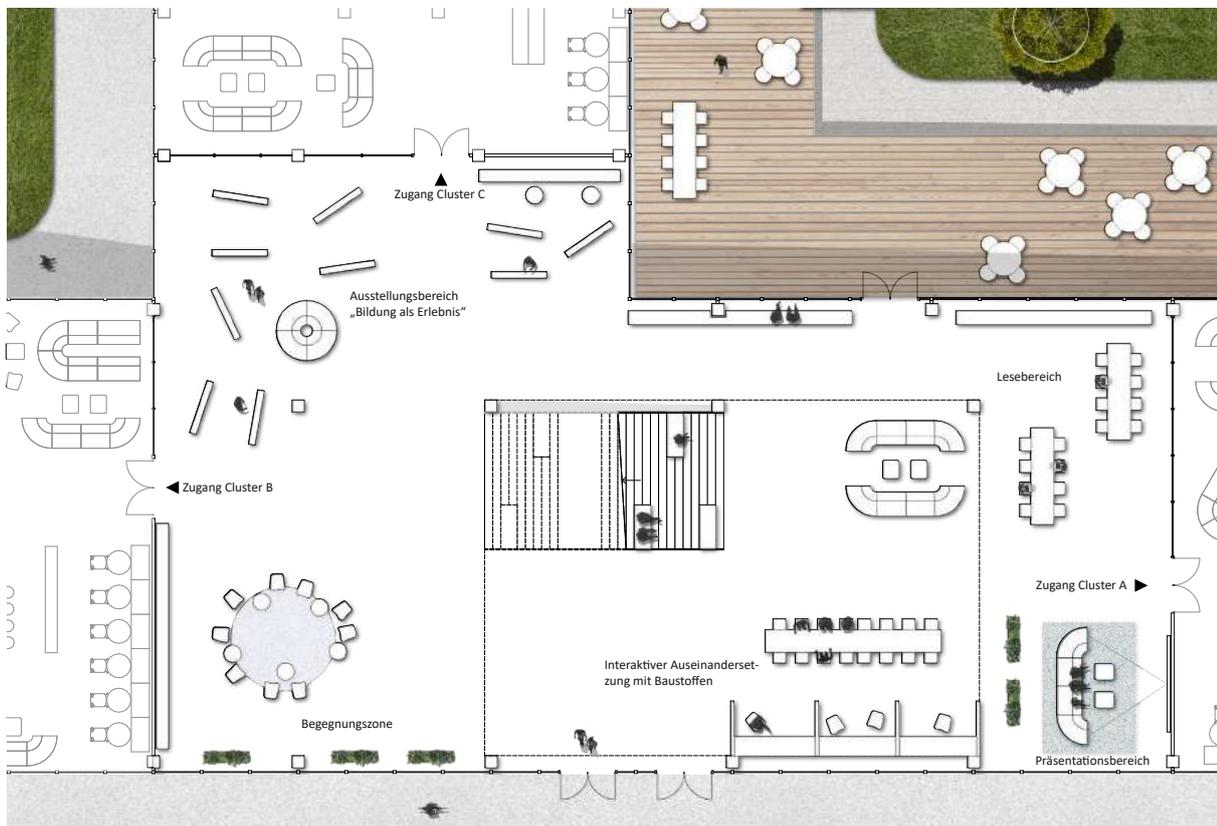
Ausgewählter Ausschnitt aus dem Grundriss zur Hervorhebung der ersten Stufe „The Gallery“
